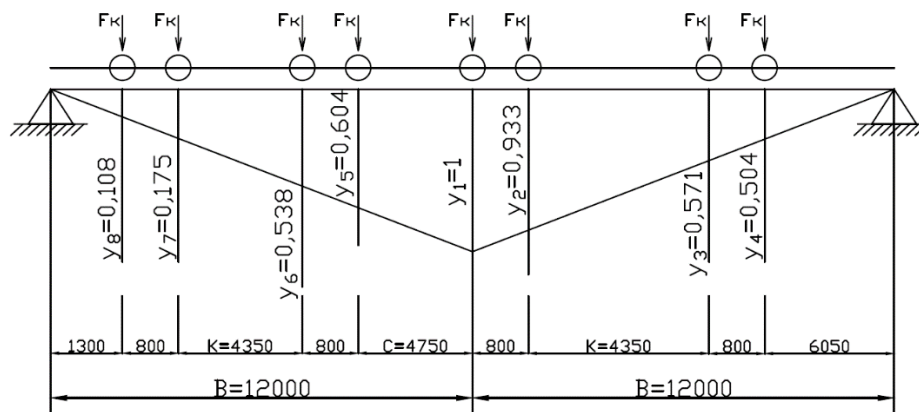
Линия влияния крановой нагрузки на две подкрановые балки
